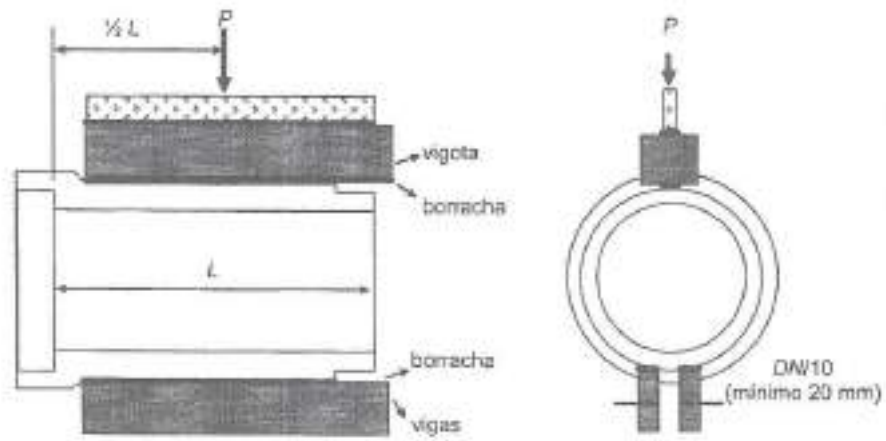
Esquema do ensaio para tubo ponta e bolsa ou macho e fêmea
